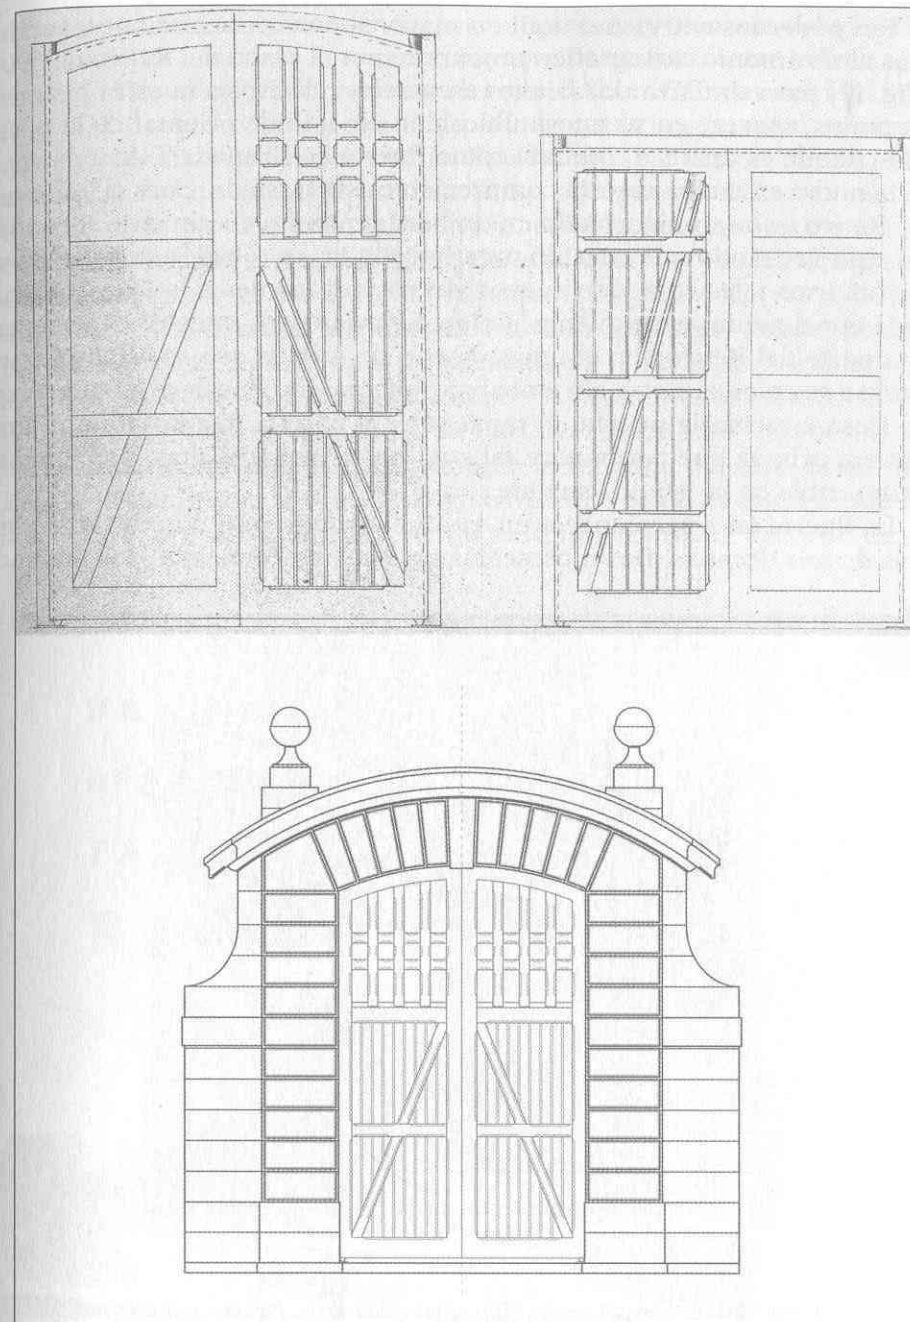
Cierres de madera proyectados por Segundo de Lema en 1861 para las Puertas del Olivar y de Atocha (A.G.P., Planos, n.º 5.236). Ajuste del primero en la Puerta de cantería conservada.
